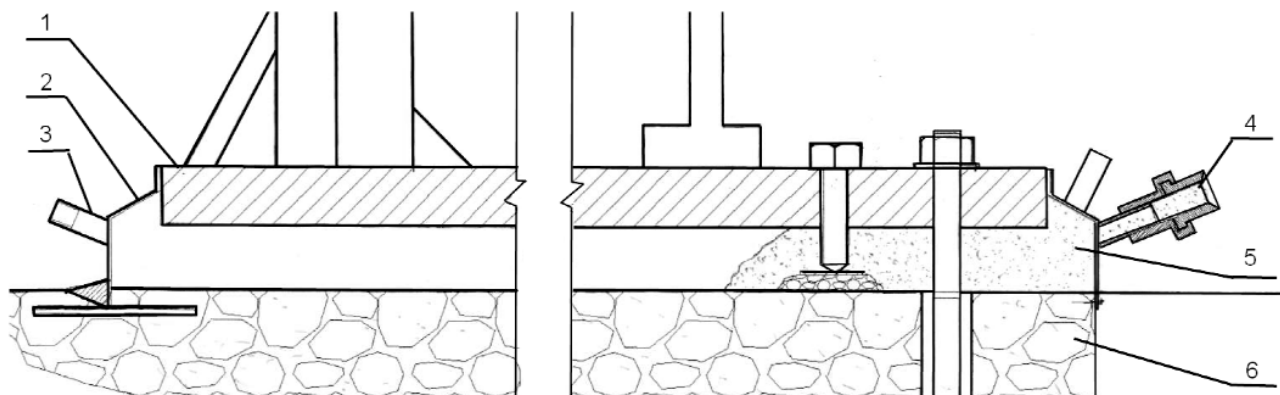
Один из вариантов устройства подливки под оборудование по трубопроводу с герметичной опалубкой: 1 — станина оборудования; 2 — герметичная опалубка; 3 — вентиляционный канал; 4 — трубопровод для подачи (нагнетания) подливки; 5 — смесь; 6 — фундамент
